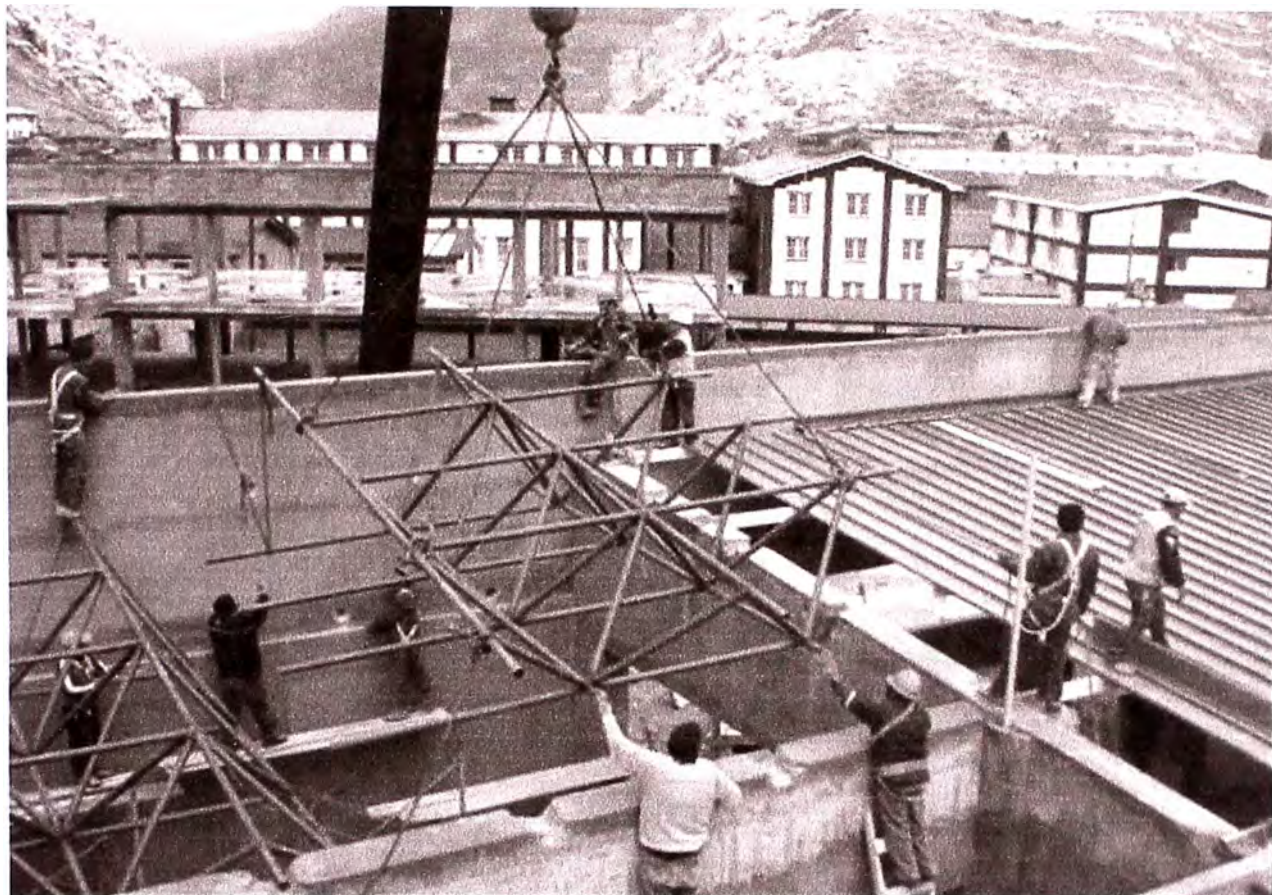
Elemento estructural prefabricado que requiere de maniobras
